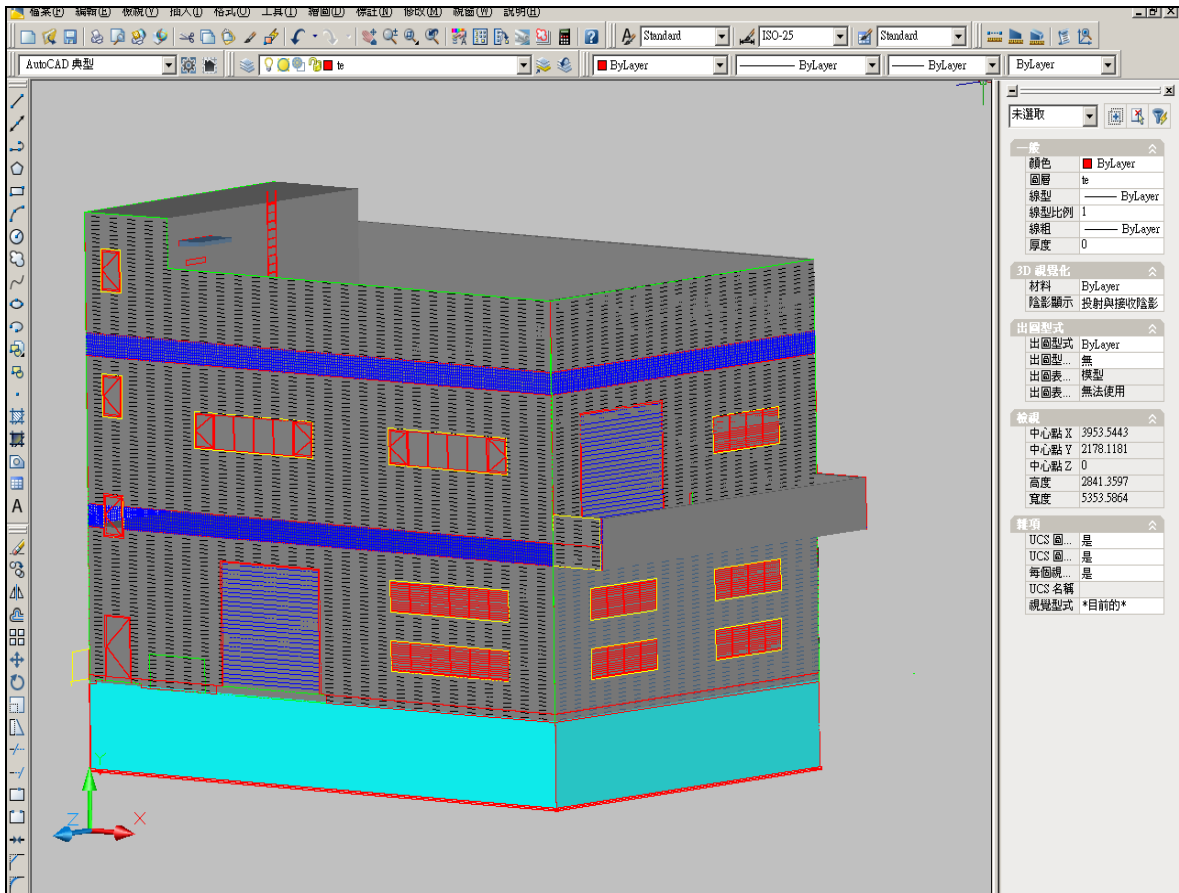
AutoCAD 繪製 傳統 3D 立面圖示
